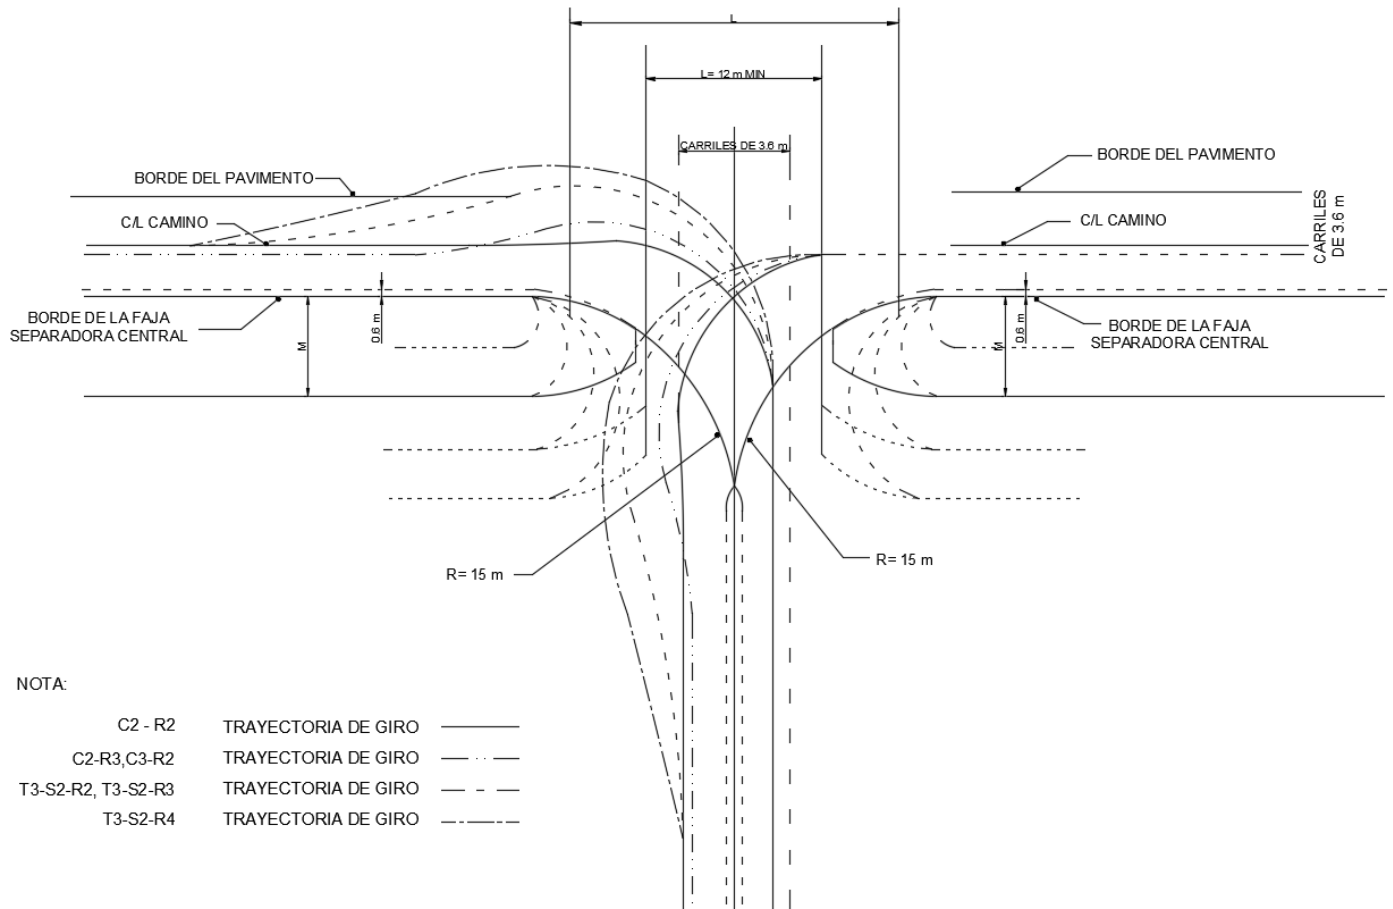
Diseño de aberturas mínimas de la faja separadora central (vehículo de proyecto C2-R2, radio de control de 23 m)
